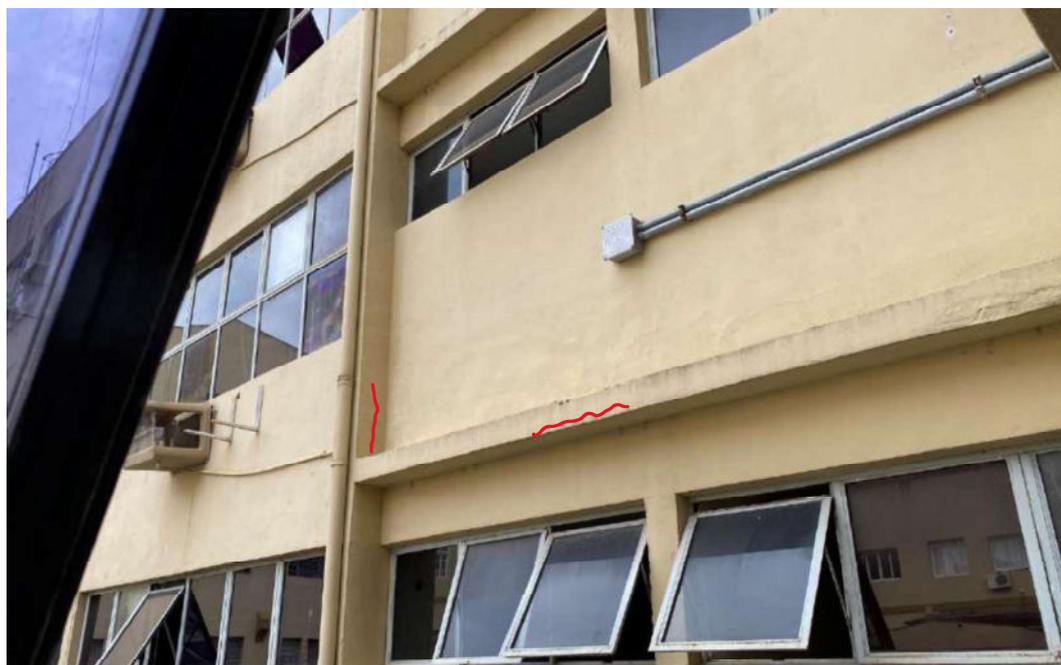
Presença de fissura na viga 337 e pilar 38 da fachada lateral
